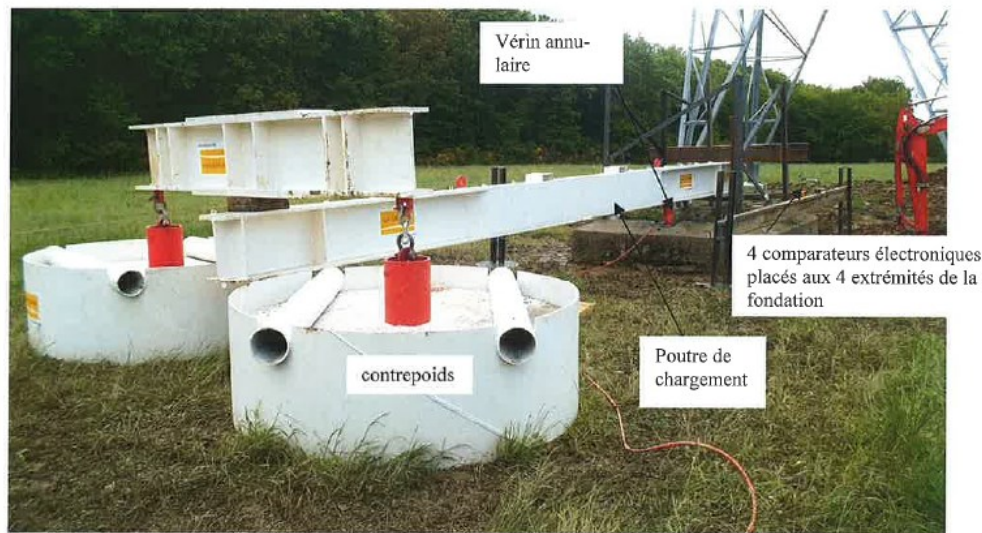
Installation des essais de renversement de la ligne 225 kV de Bayet-Montvicq [Spie fondations, 2014]
